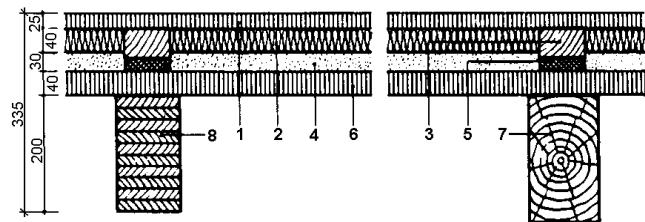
Деревянные балочные перекрытия. Вариант II.
